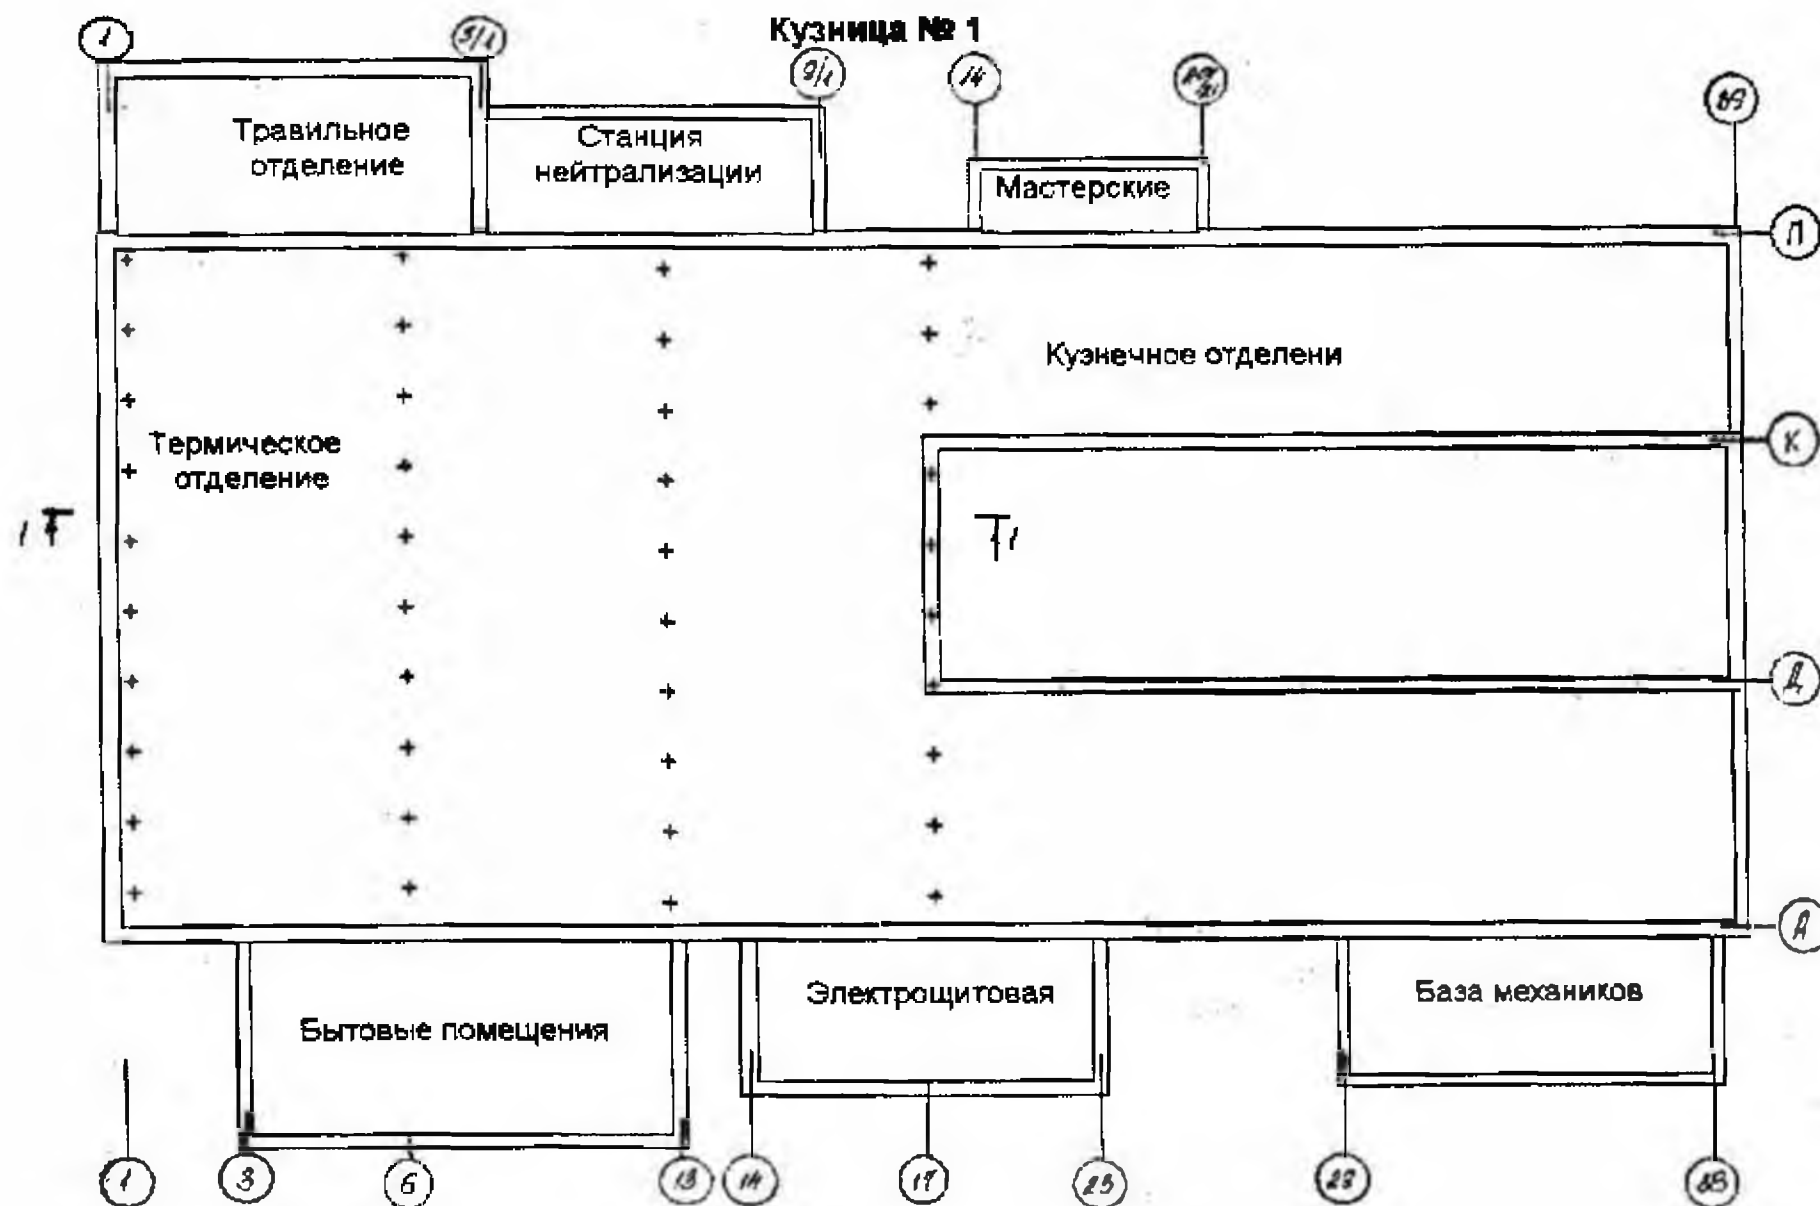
План кузнечного цеха на отметке 0.00
